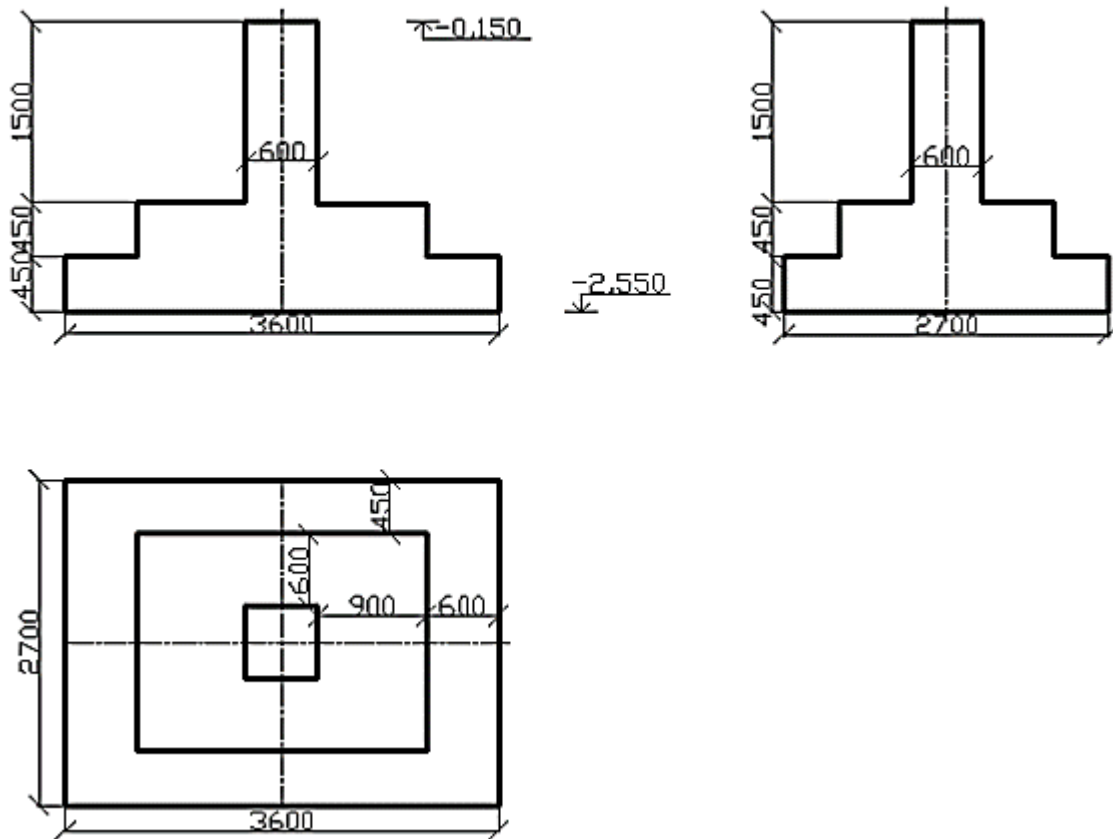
Ступчастий фундамент під крайню рядову колону (зі збільшеною висотою сходинок)
